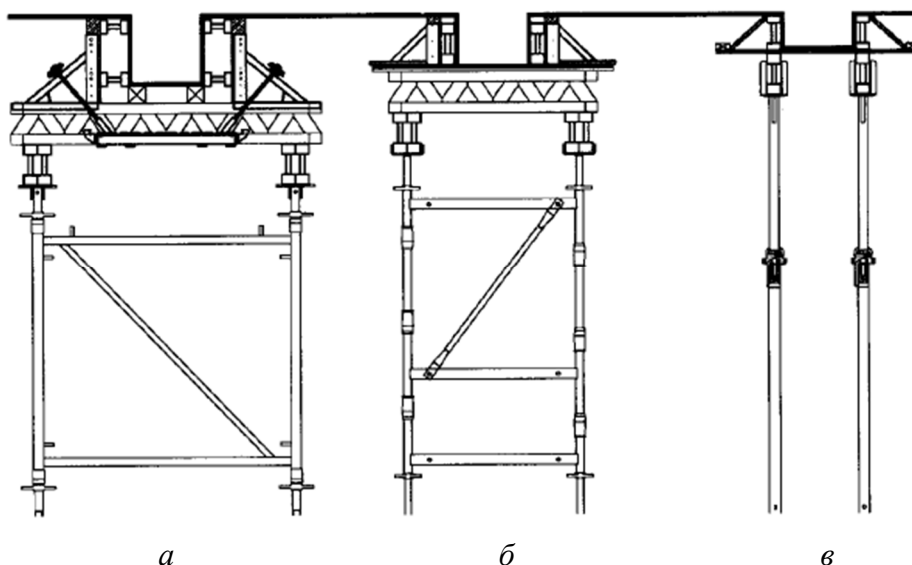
Опалубка ригелей: *а* – усиленная конструкция на опорных башнях; *б* – на рамных стойках; *в* – на стойках
